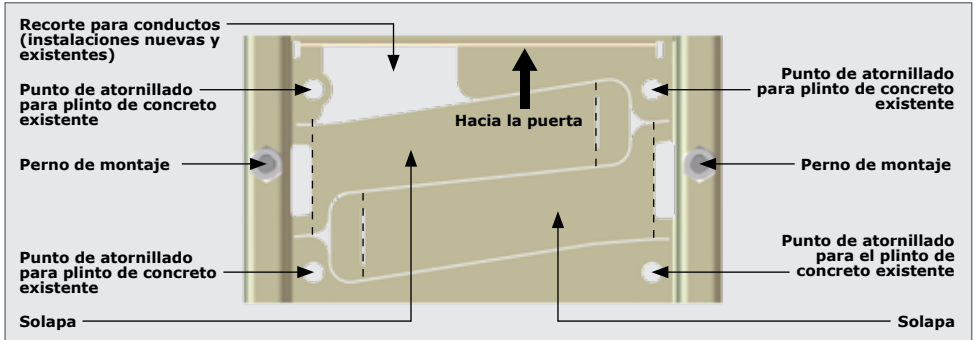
MONTAJE DE LA PLACA DE CIMENTACIÓN - VISTA SUPERIOR
